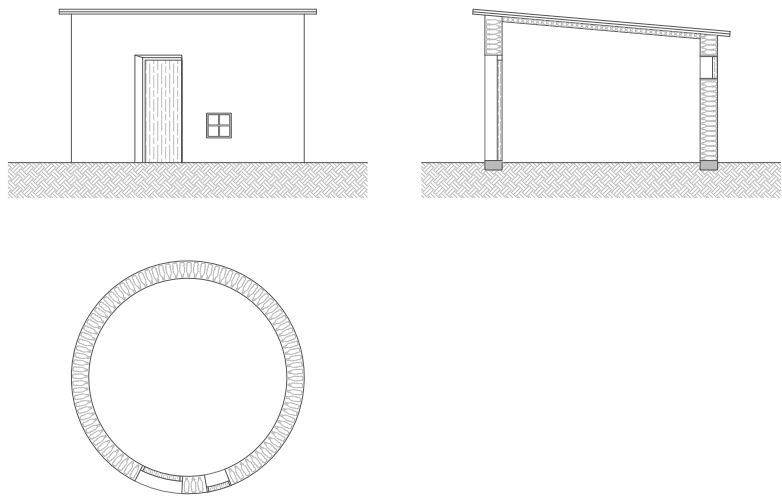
Planta, alzado y sección de una de las viviendas de Tinduf.
